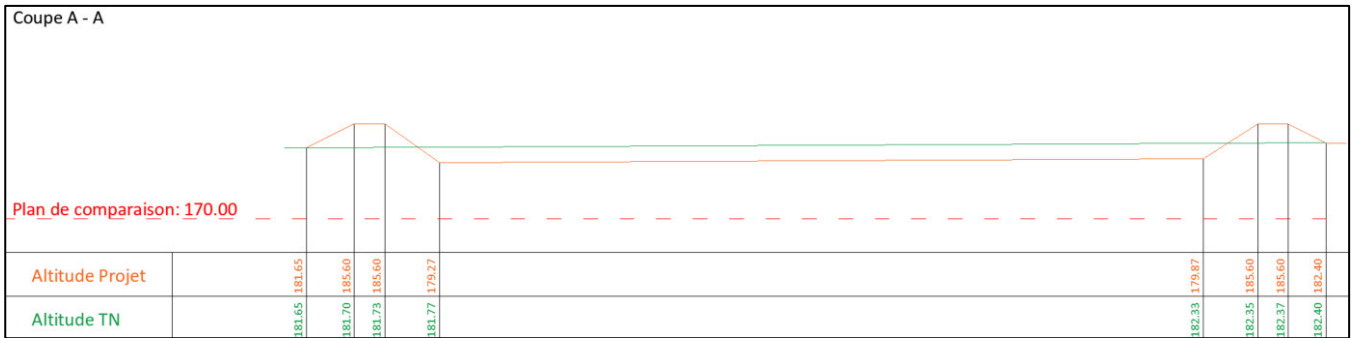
Coupe de l'ouvrage (GEOBTP BERNARDEAU)
